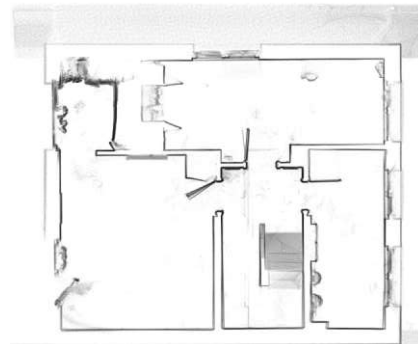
SLAM-Punktwolke im Grundriss
